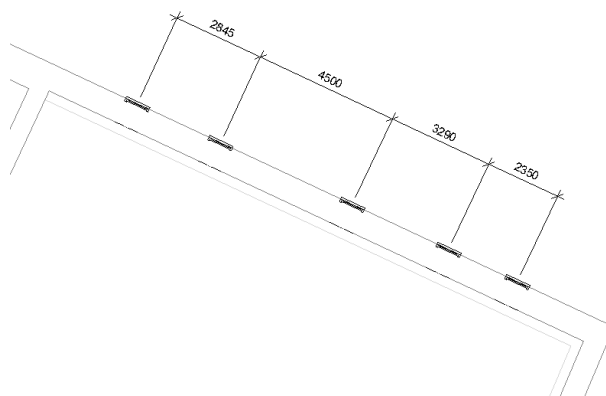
Okno zvolené pro virtuální model mincovny a pivovaru
